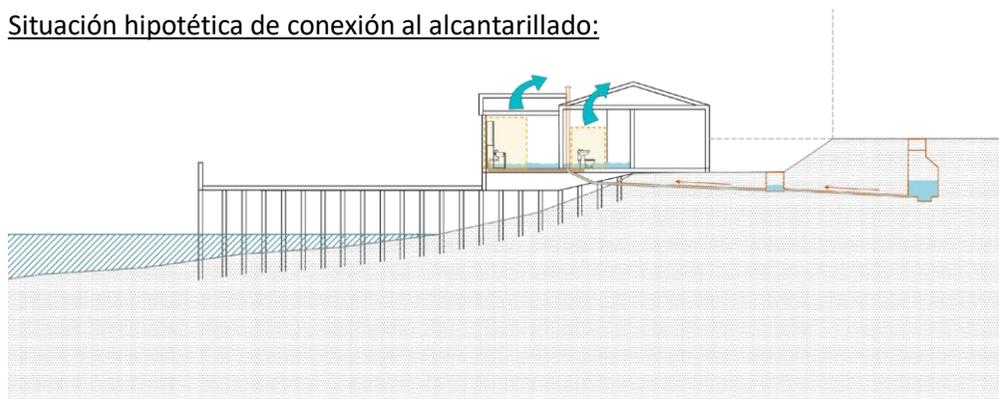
Corte explicativo de situación hipotética palafito de 1 piso si actualmente se conectara al alcantarillado.
